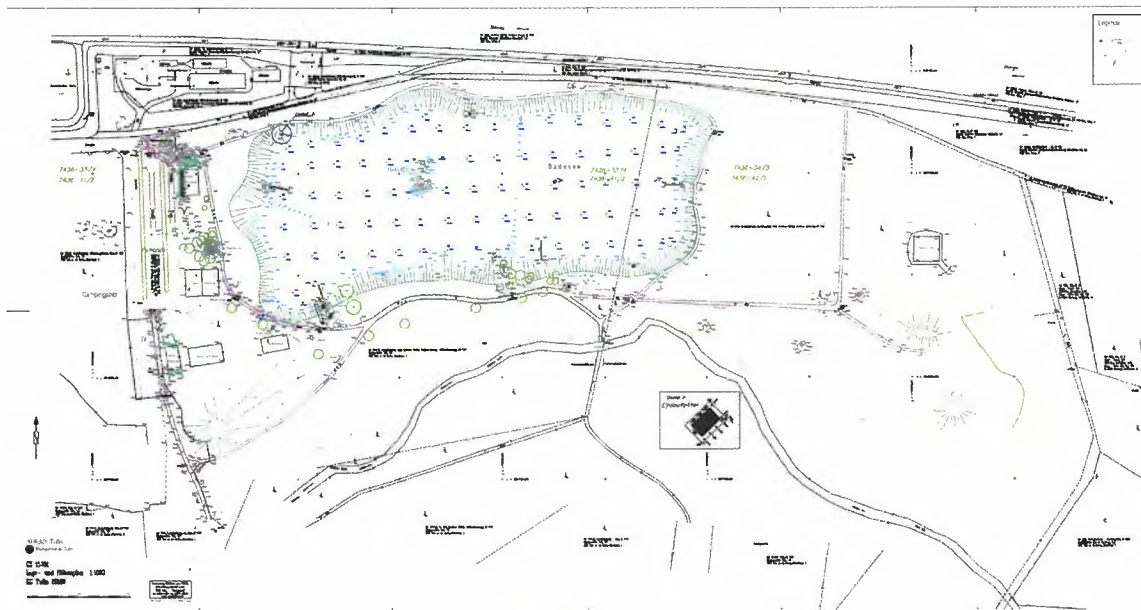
Ausschnitt Höhen-Lageplan (GZ.15701-L.dwg, März 2010)
